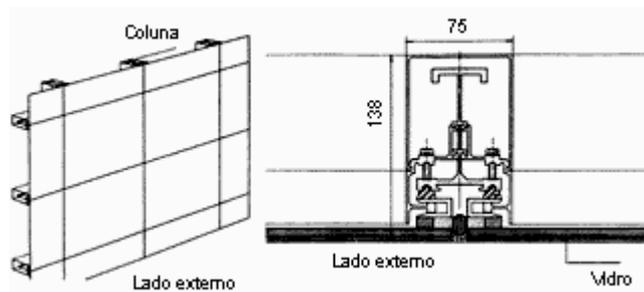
Fachada-cortina *Structural Glazing*: o vidro passa a ser colado com silicone estrutural, originando panos de vidro contínuos
